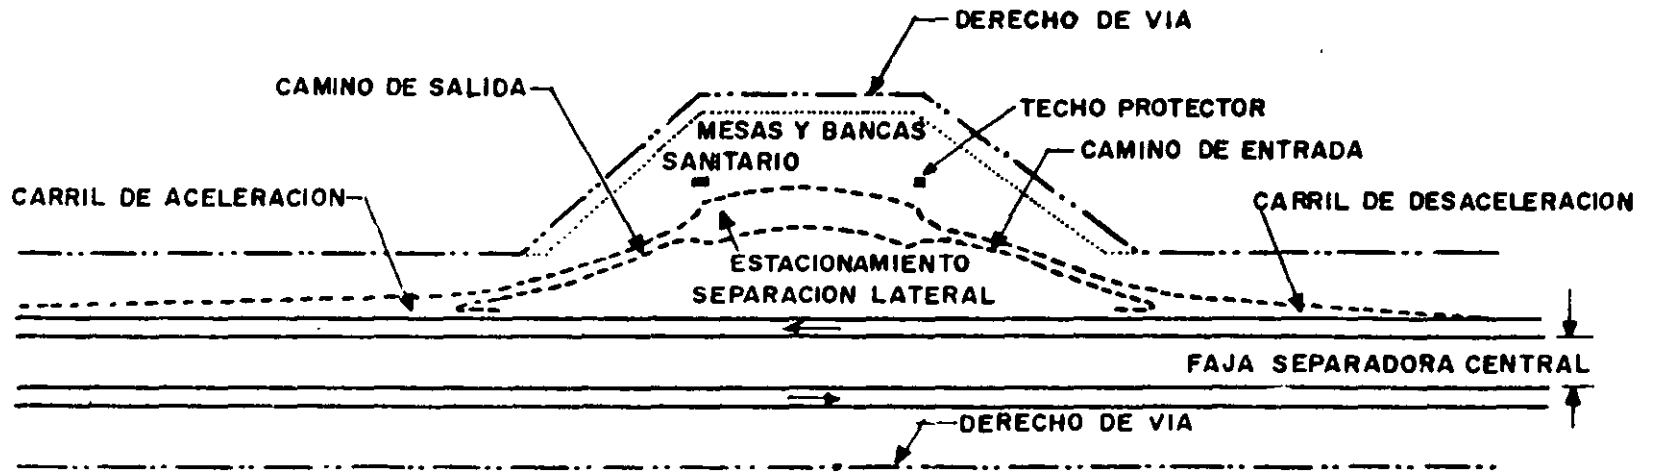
ZONA DE DESCANSO TERMINOS USADOS
